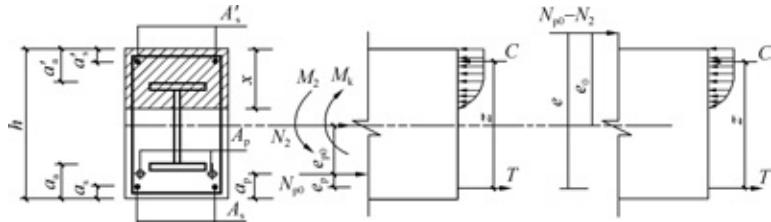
2 预应力型钢混凝土框架梁最大裂缝宽度计算简图
